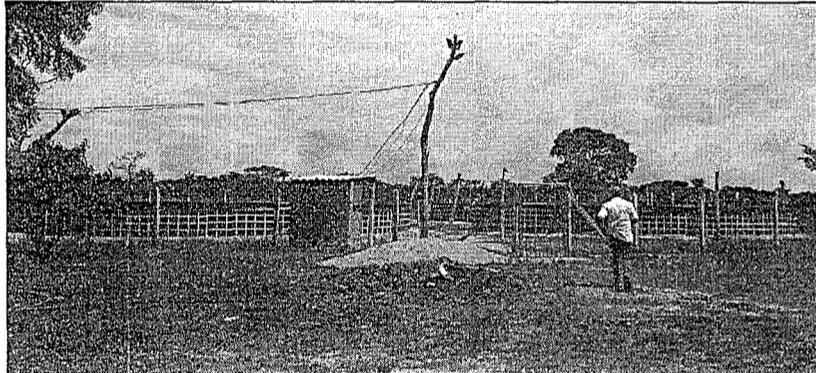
Vista general, infraestructura (Proyecto Piscícola).
